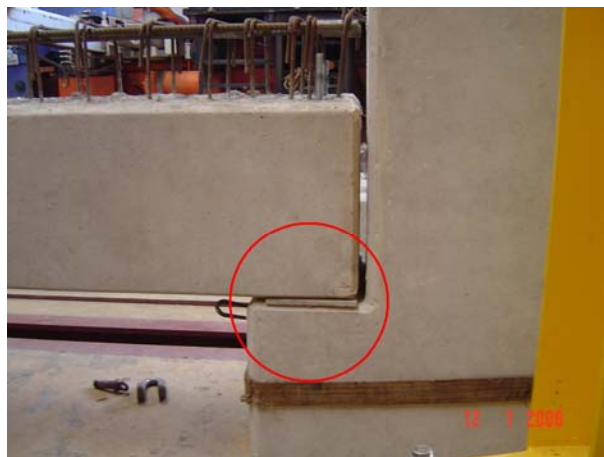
Içamento do elemento com trecho de pilar.
